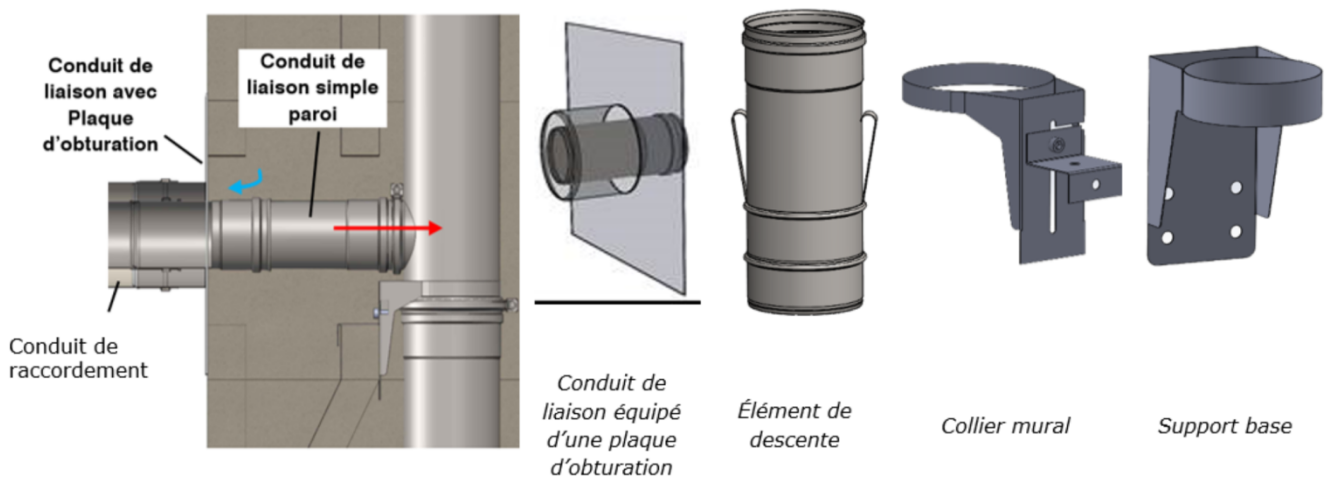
Mise en place du conduit de liaison, version DINAGAS 3CE+ SW pour rénovation dans un conduit existant et accessoires de pose
